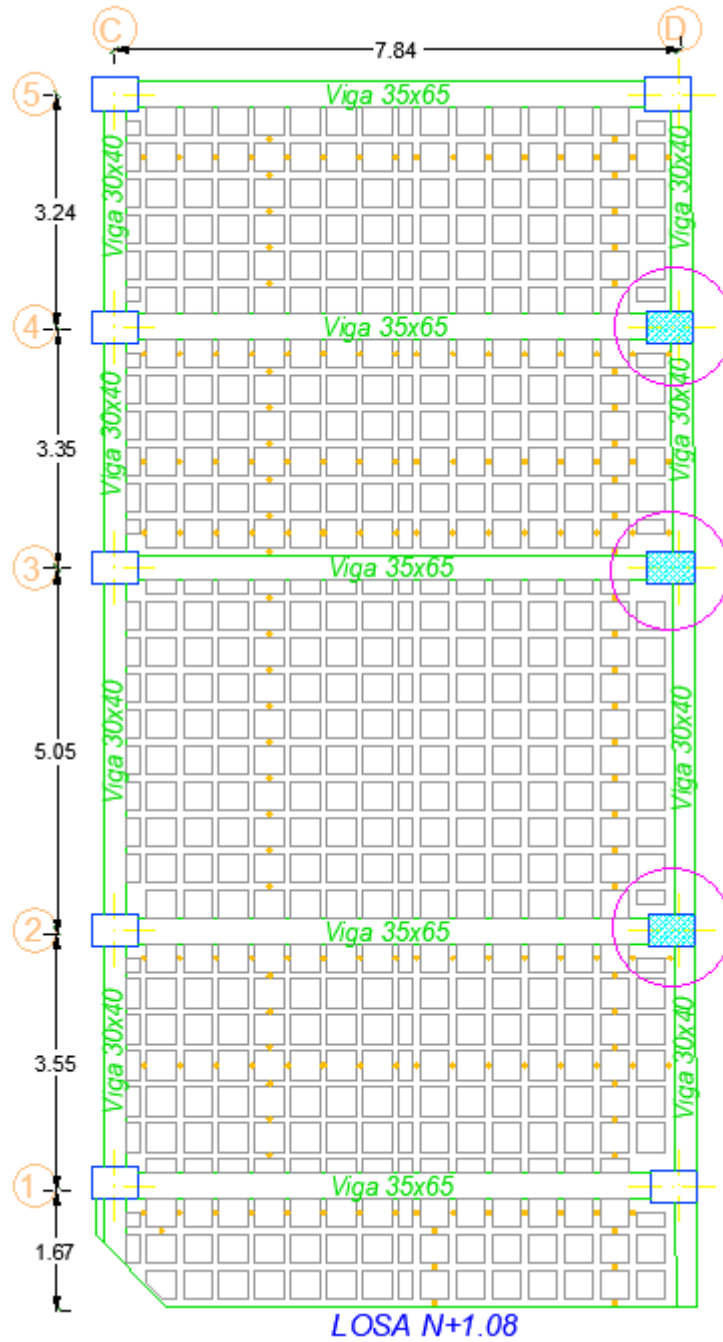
Esclerometría de la losa y vigas del eje D - Nivel +1.08
